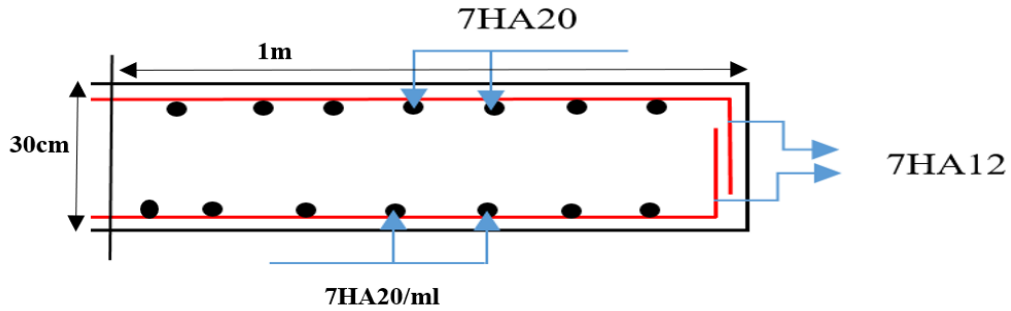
FERRAILLAGE DE LA DALLE DE TRANSITION
